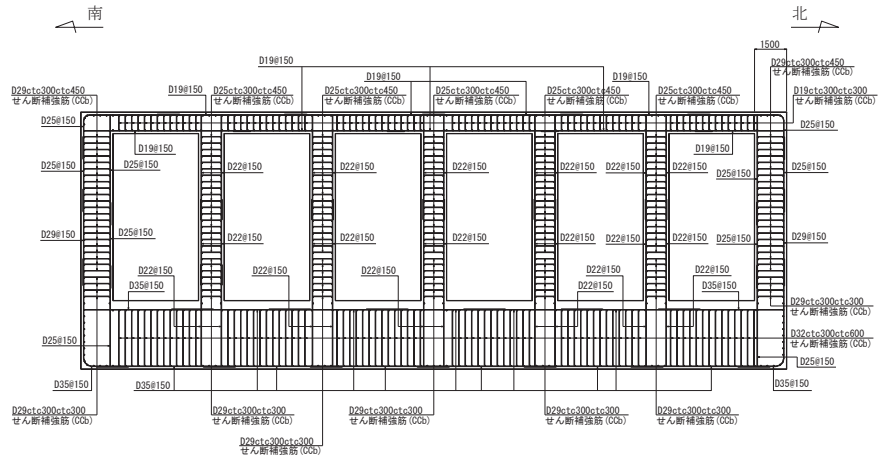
取水口概略配筋図 (A-A 断面, 標準部)
